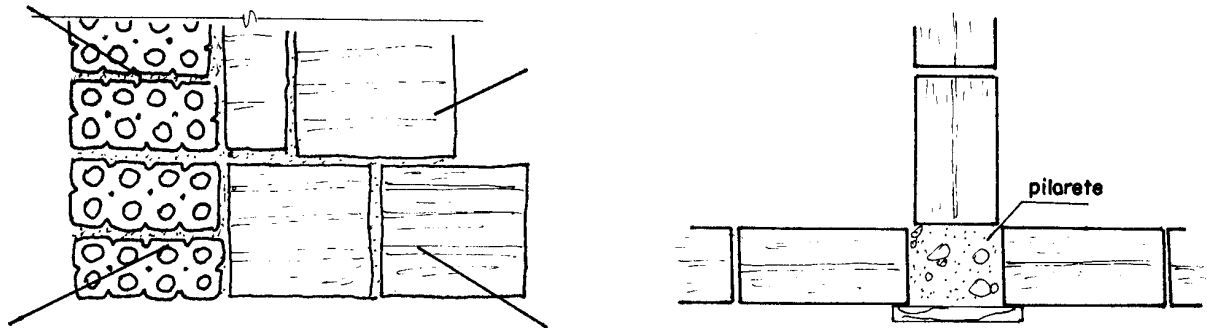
Exemplo de amarração nas alvenaria de tijolo furado
